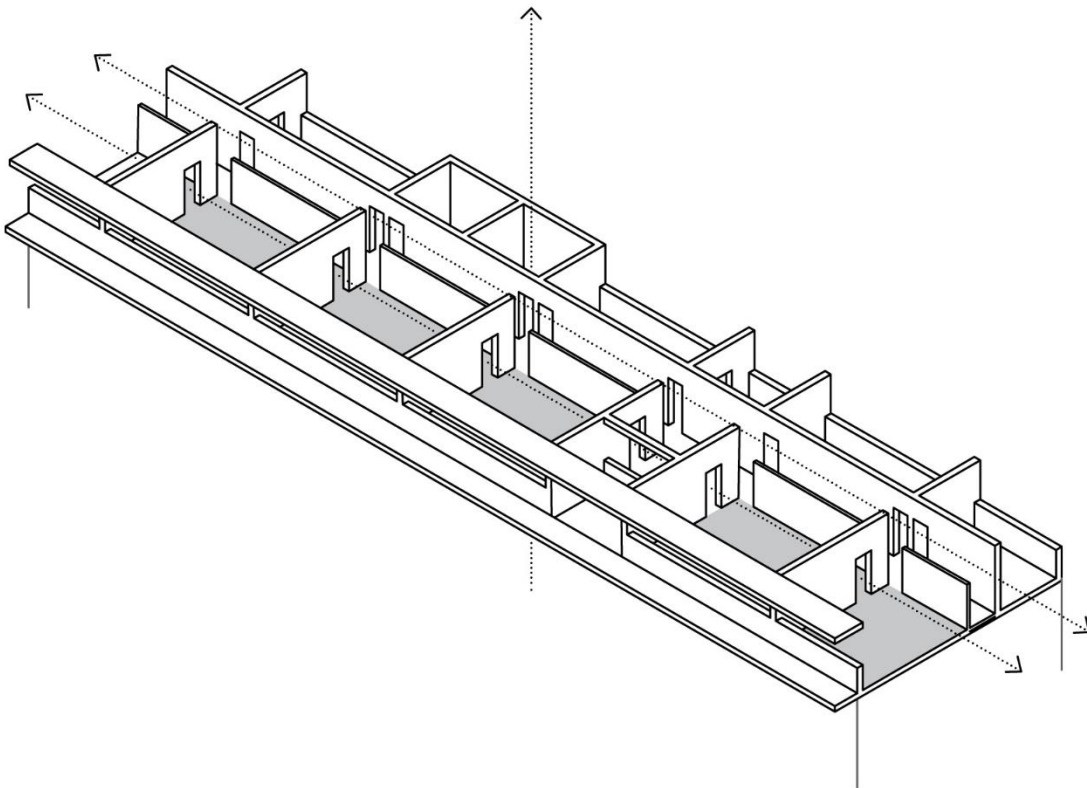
Localização de salas de aula em planta e *eixos*, EAUM. Esc:1:200
